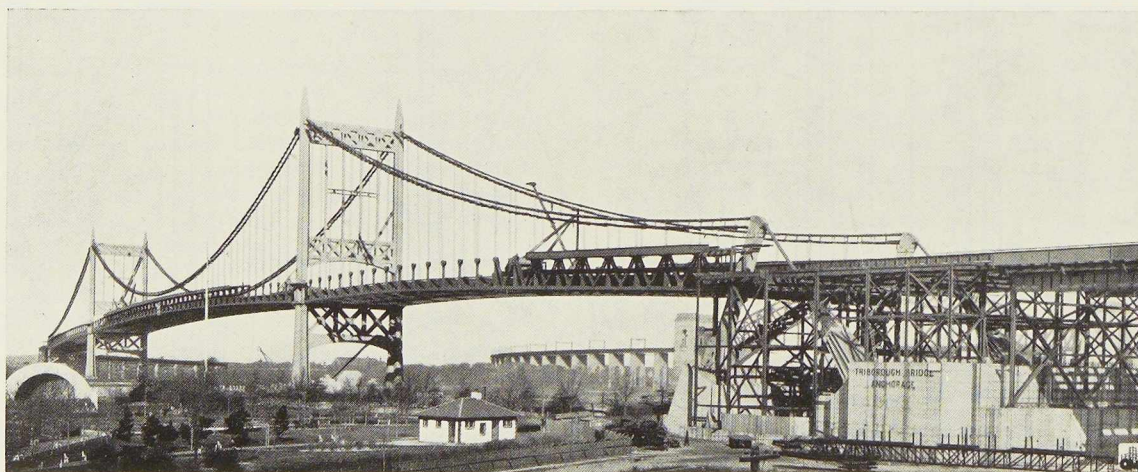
Vue générale du pont suspendu sur East River en cours de construction. Au premier plan à droite un massif d'ancrage en béton avec parement en granit. Les poutres de raideur sont partiellement montées.
